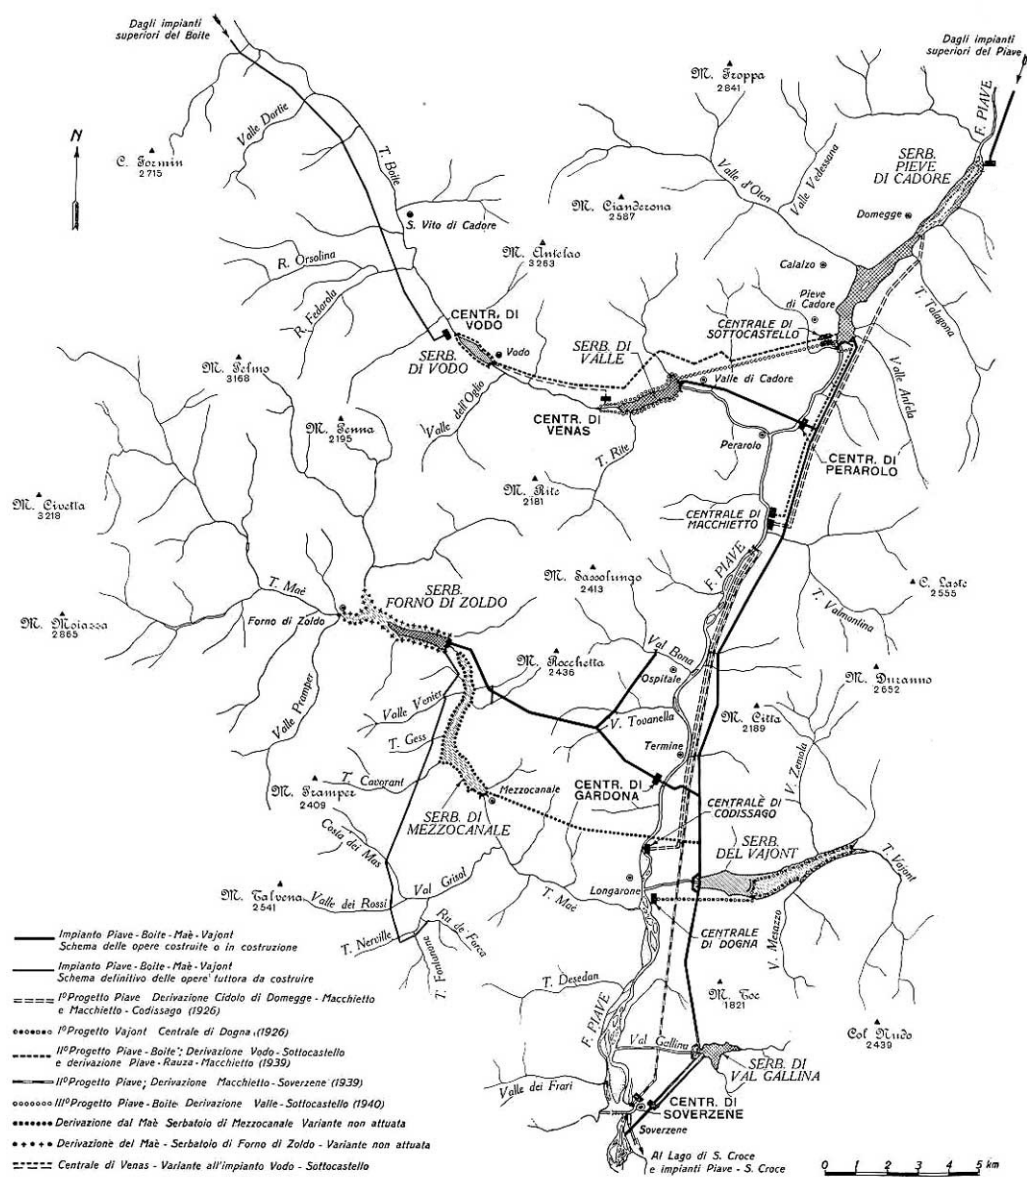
Planimetria schematica impianto Piave-Boite-Maè-Vajont.
